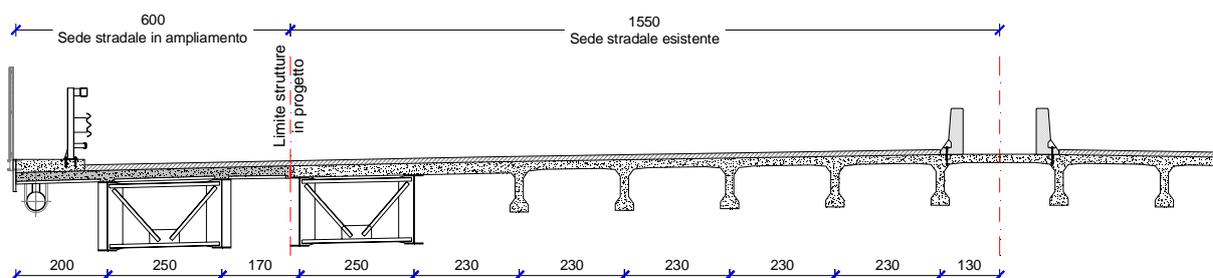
Ponte sul Lambro: sezione trasversale dell'impalcato
